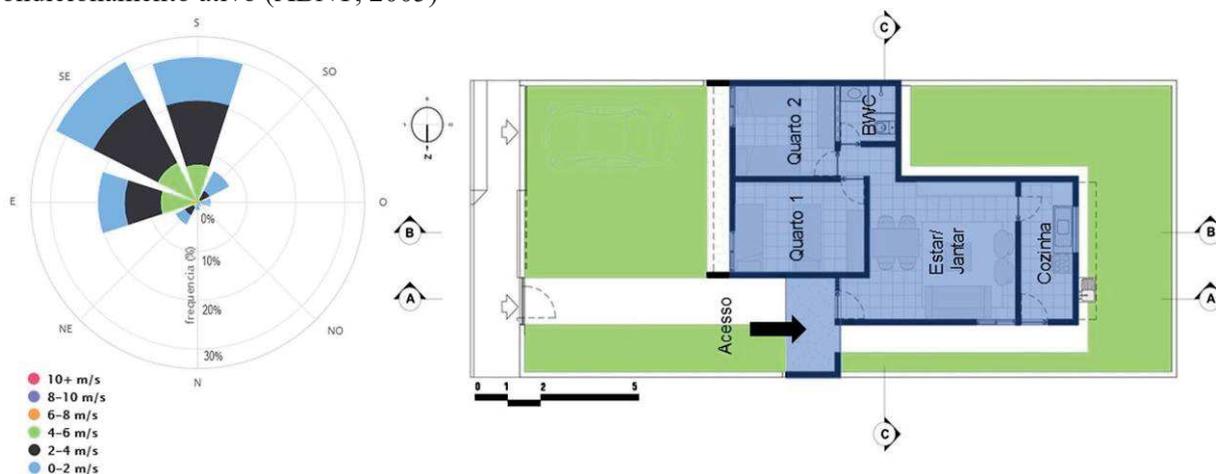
Planta Baixa. Fonte: Adaptado Projeteec e Jirau Arquitetura Urbanismo, s.d.
